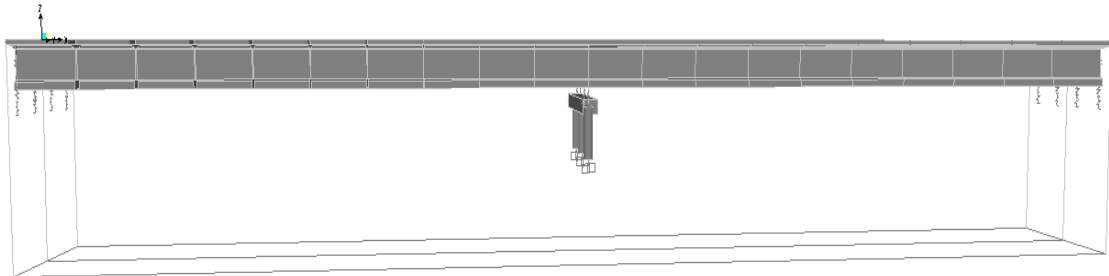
SECCION LONGITUDINAL DEL PUENTE
